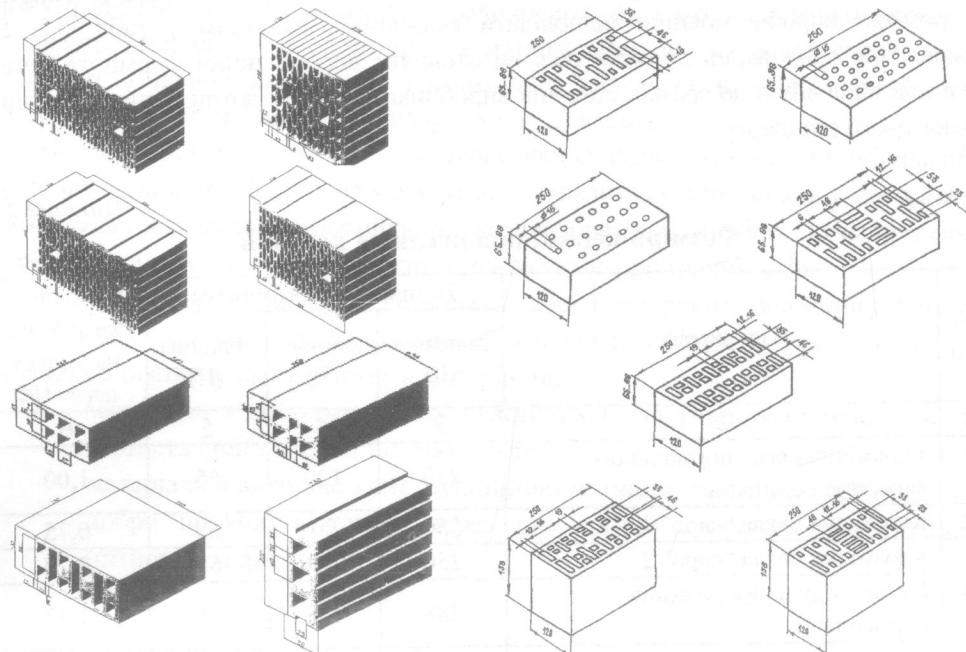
Рекомендовані форми і розміри виробів пластичного формування та напівсухого пресування
